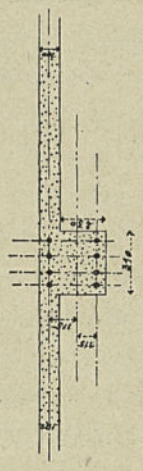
Poutre. - Coupe V. - (Pl I Fig 3)
